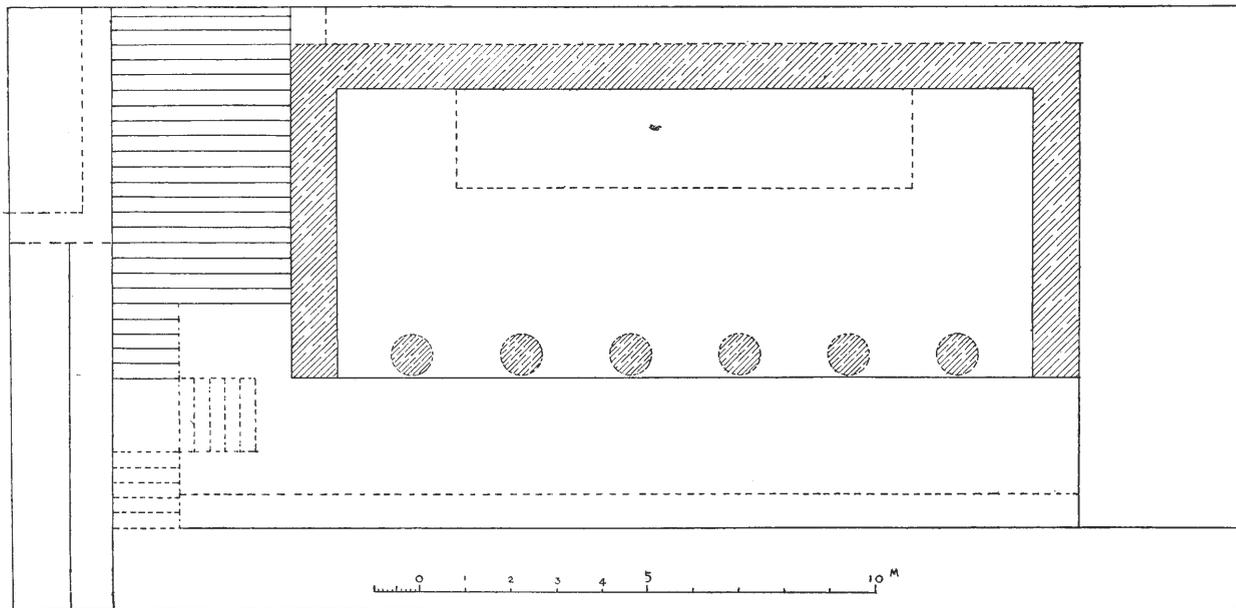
Ex-voto de Kratéros, plan restauré.
